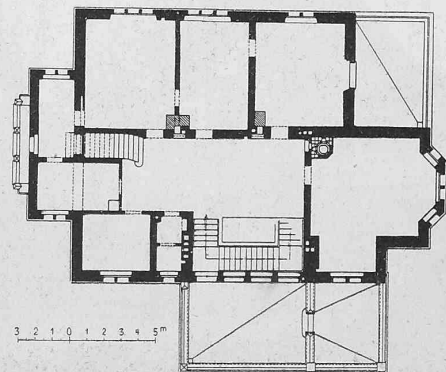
Grundriss vom ersten Obergeschoss.
